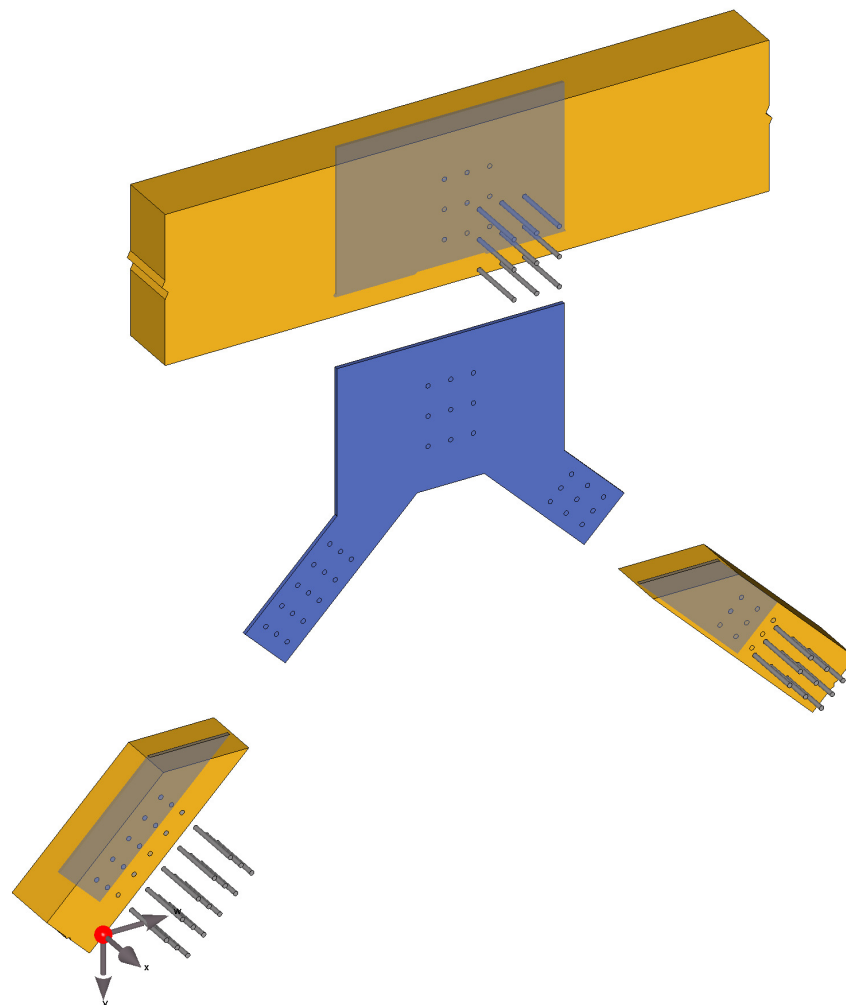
Explosionszeichnung des Anschlusses für Fachwerk FB1.j
